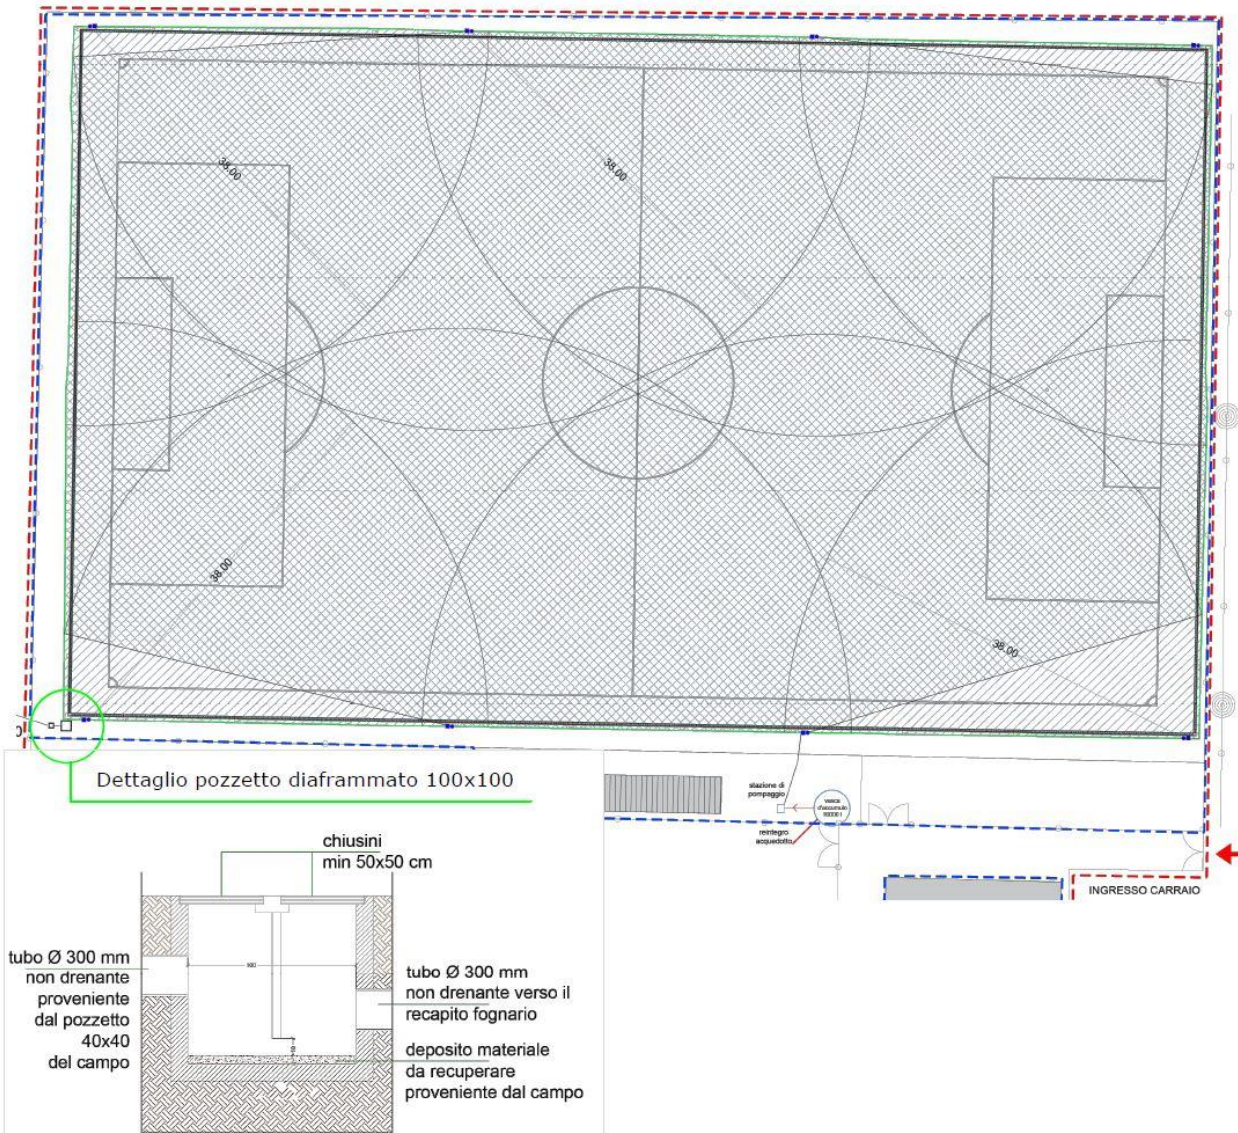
Estratto Tav.03.b.2\_Stato di progetto - Campo da calcio
